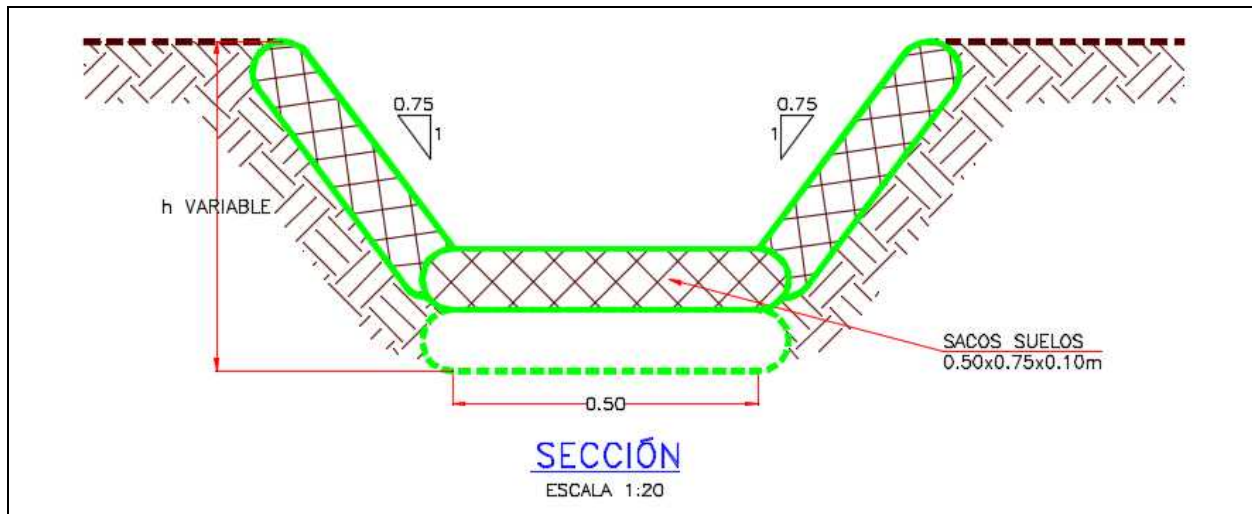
Detalle sección y perfil cuneta trapezoidal en sacos de suelo
